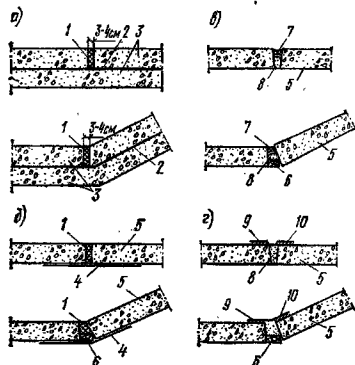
Конструкции швов бетонной (железобетонной) одежды каналов
